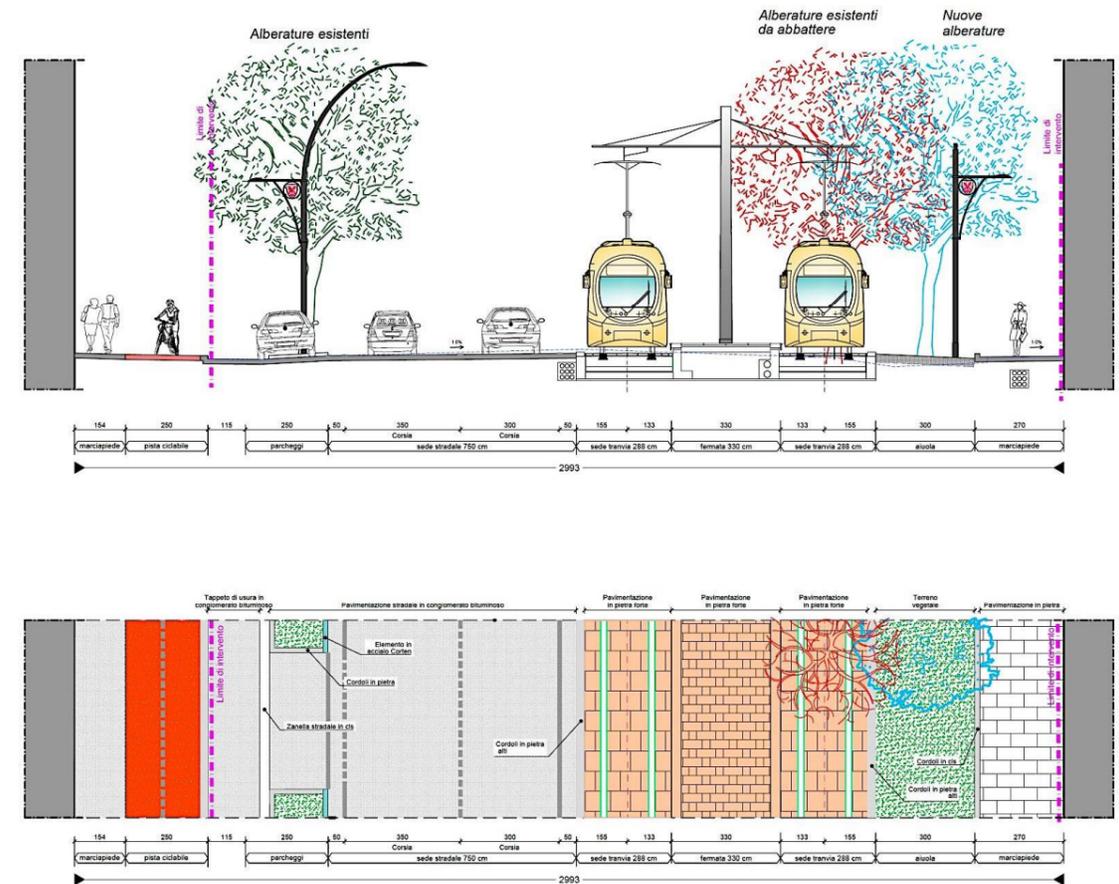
Sezione tipo viale Don G. Minzoni-Progetto
